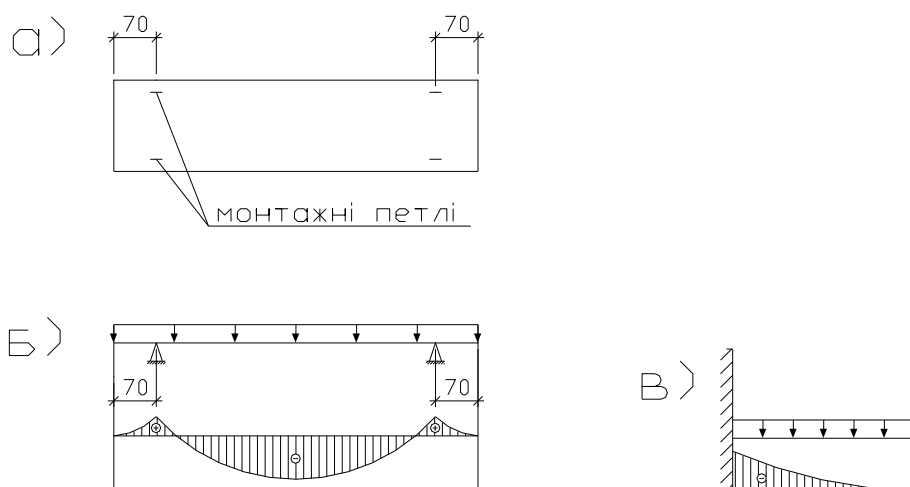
а) Схема багатопустотної залізобетонної плити перекриття
